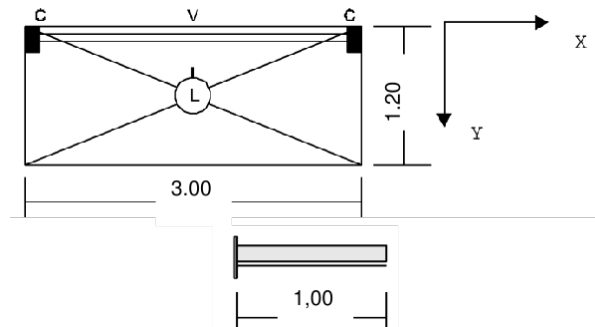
Planta de la columna correspondiente al ejercicio 2)
